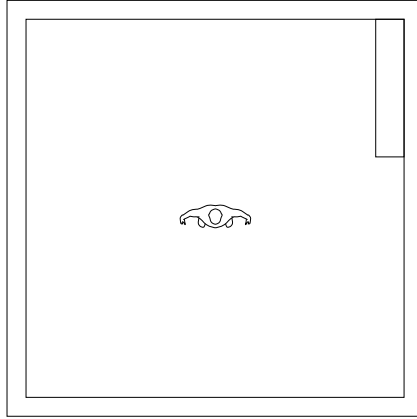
Pos. IV.II | Grundriss – M.1:100
